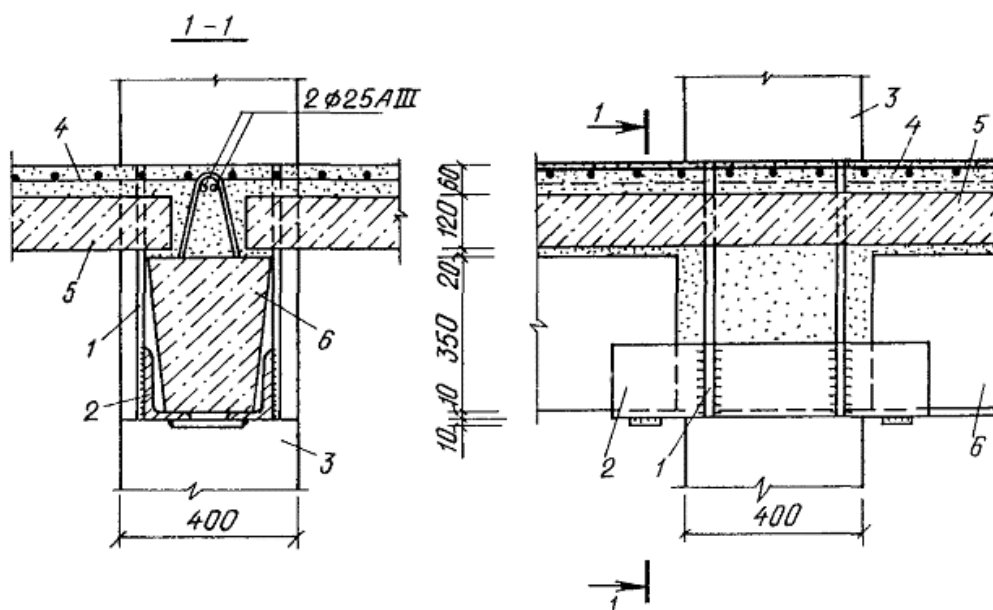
Узел сопряжения ригеля с колонной 40×40 см
